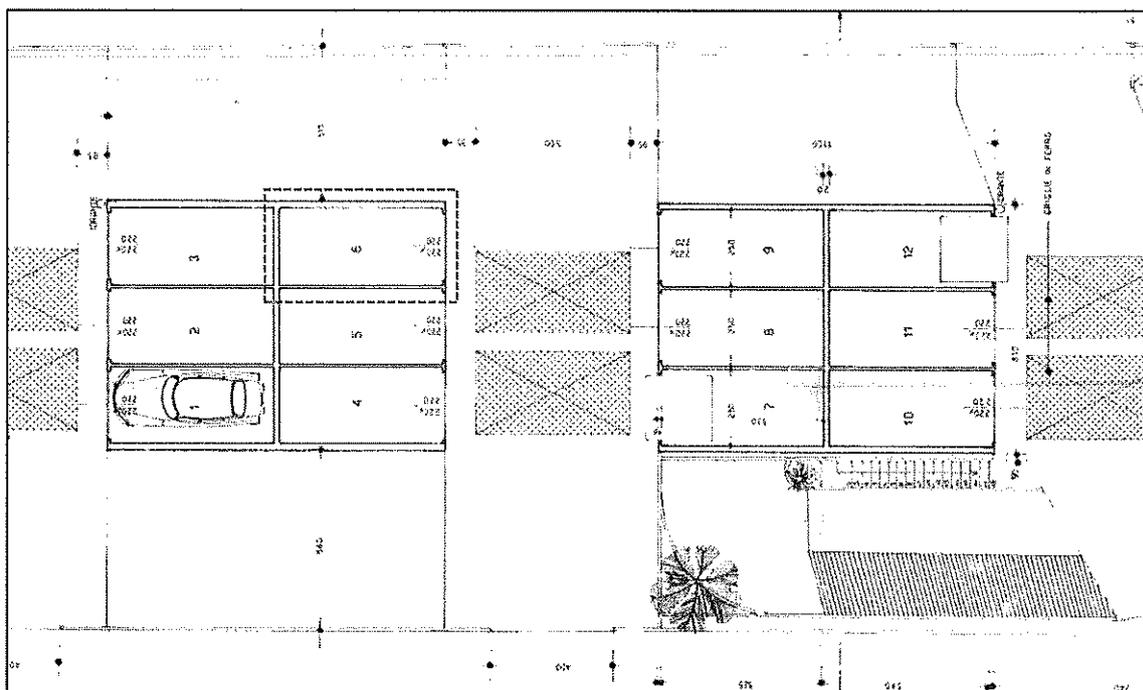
estratto tavola di progetto piano terra ed individuazione box
